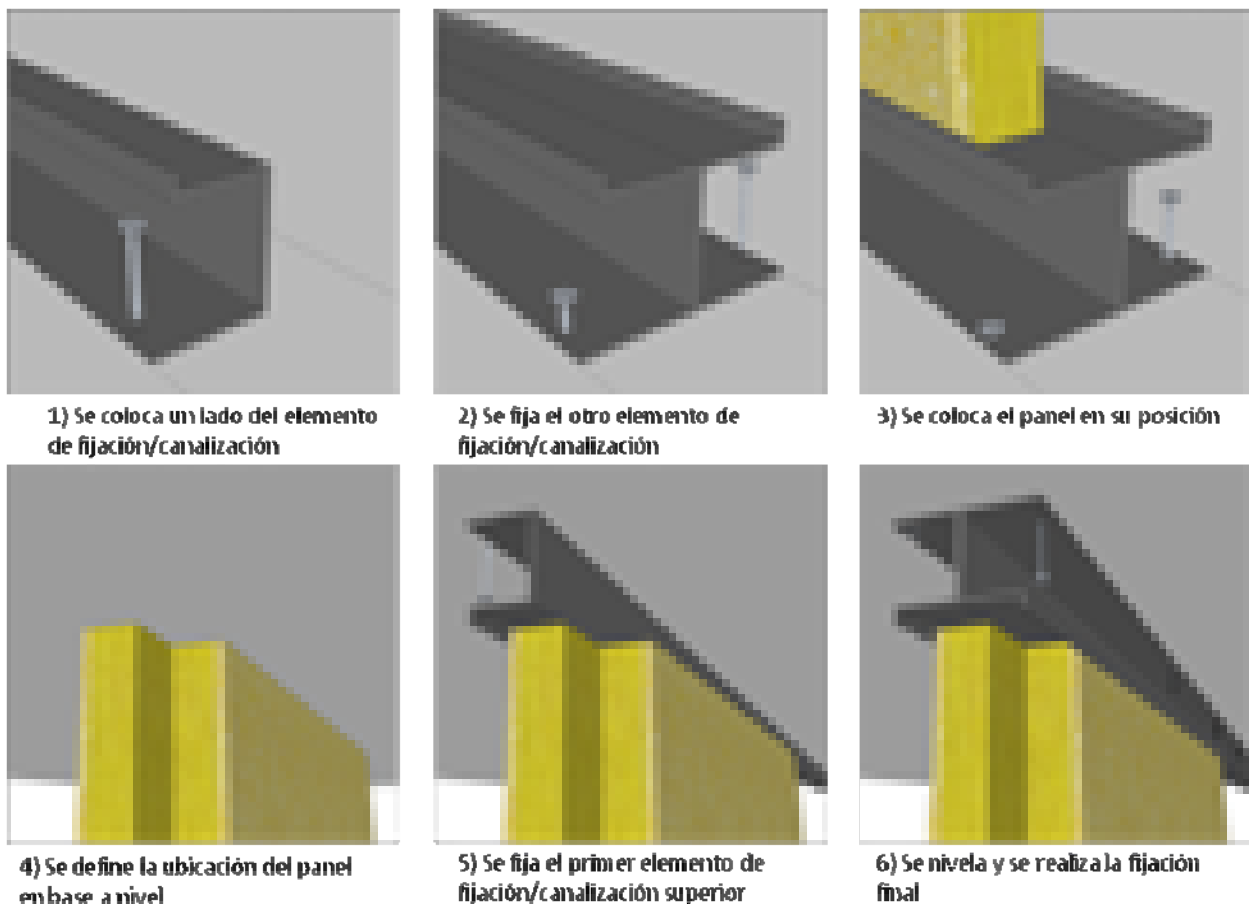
Esquema de instalación de elementos de fijación/canalización. Fuente: Elaboración propia, 2012.
